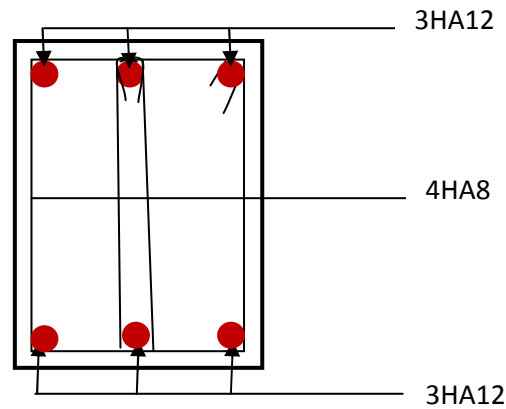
Ferrailage en travée d'une poutre secondaire.
